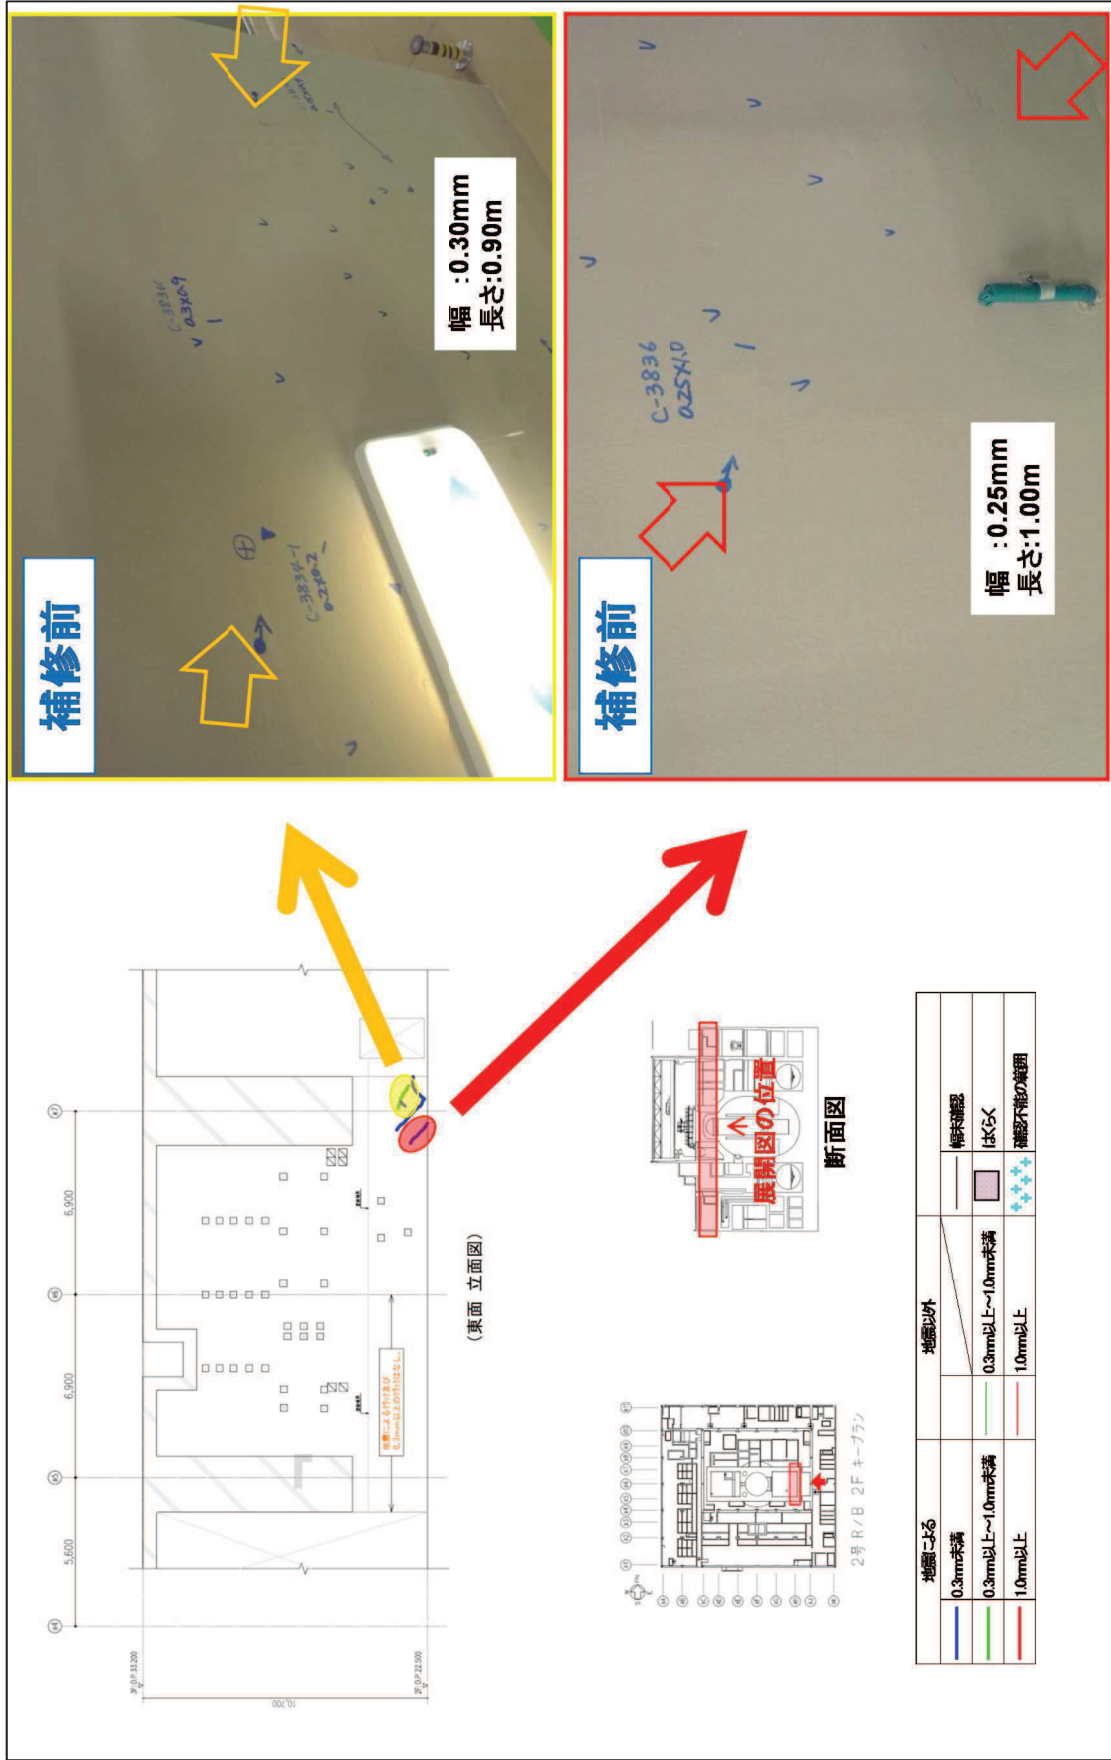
鉄筋コンクリート躯体のひび割れの例（原子炉建屋地上2階）
